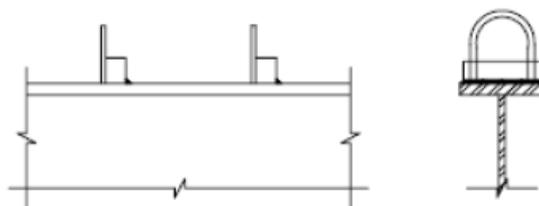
Conector rígido (Chapman, 1964 apud Chaves, 2009)
